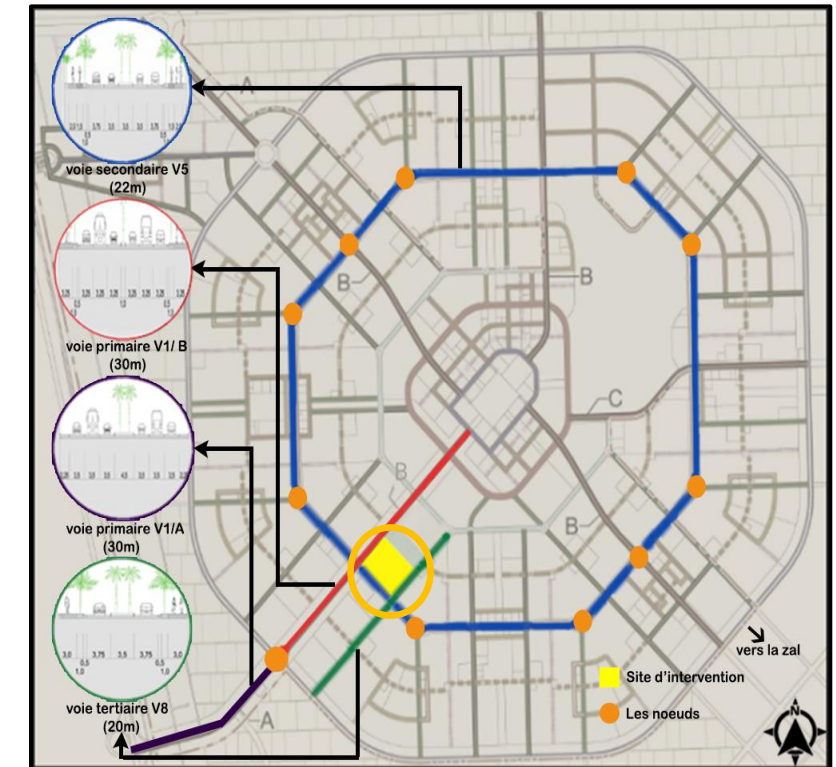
Accessibilité au site et des coupes transversales sur les voies
